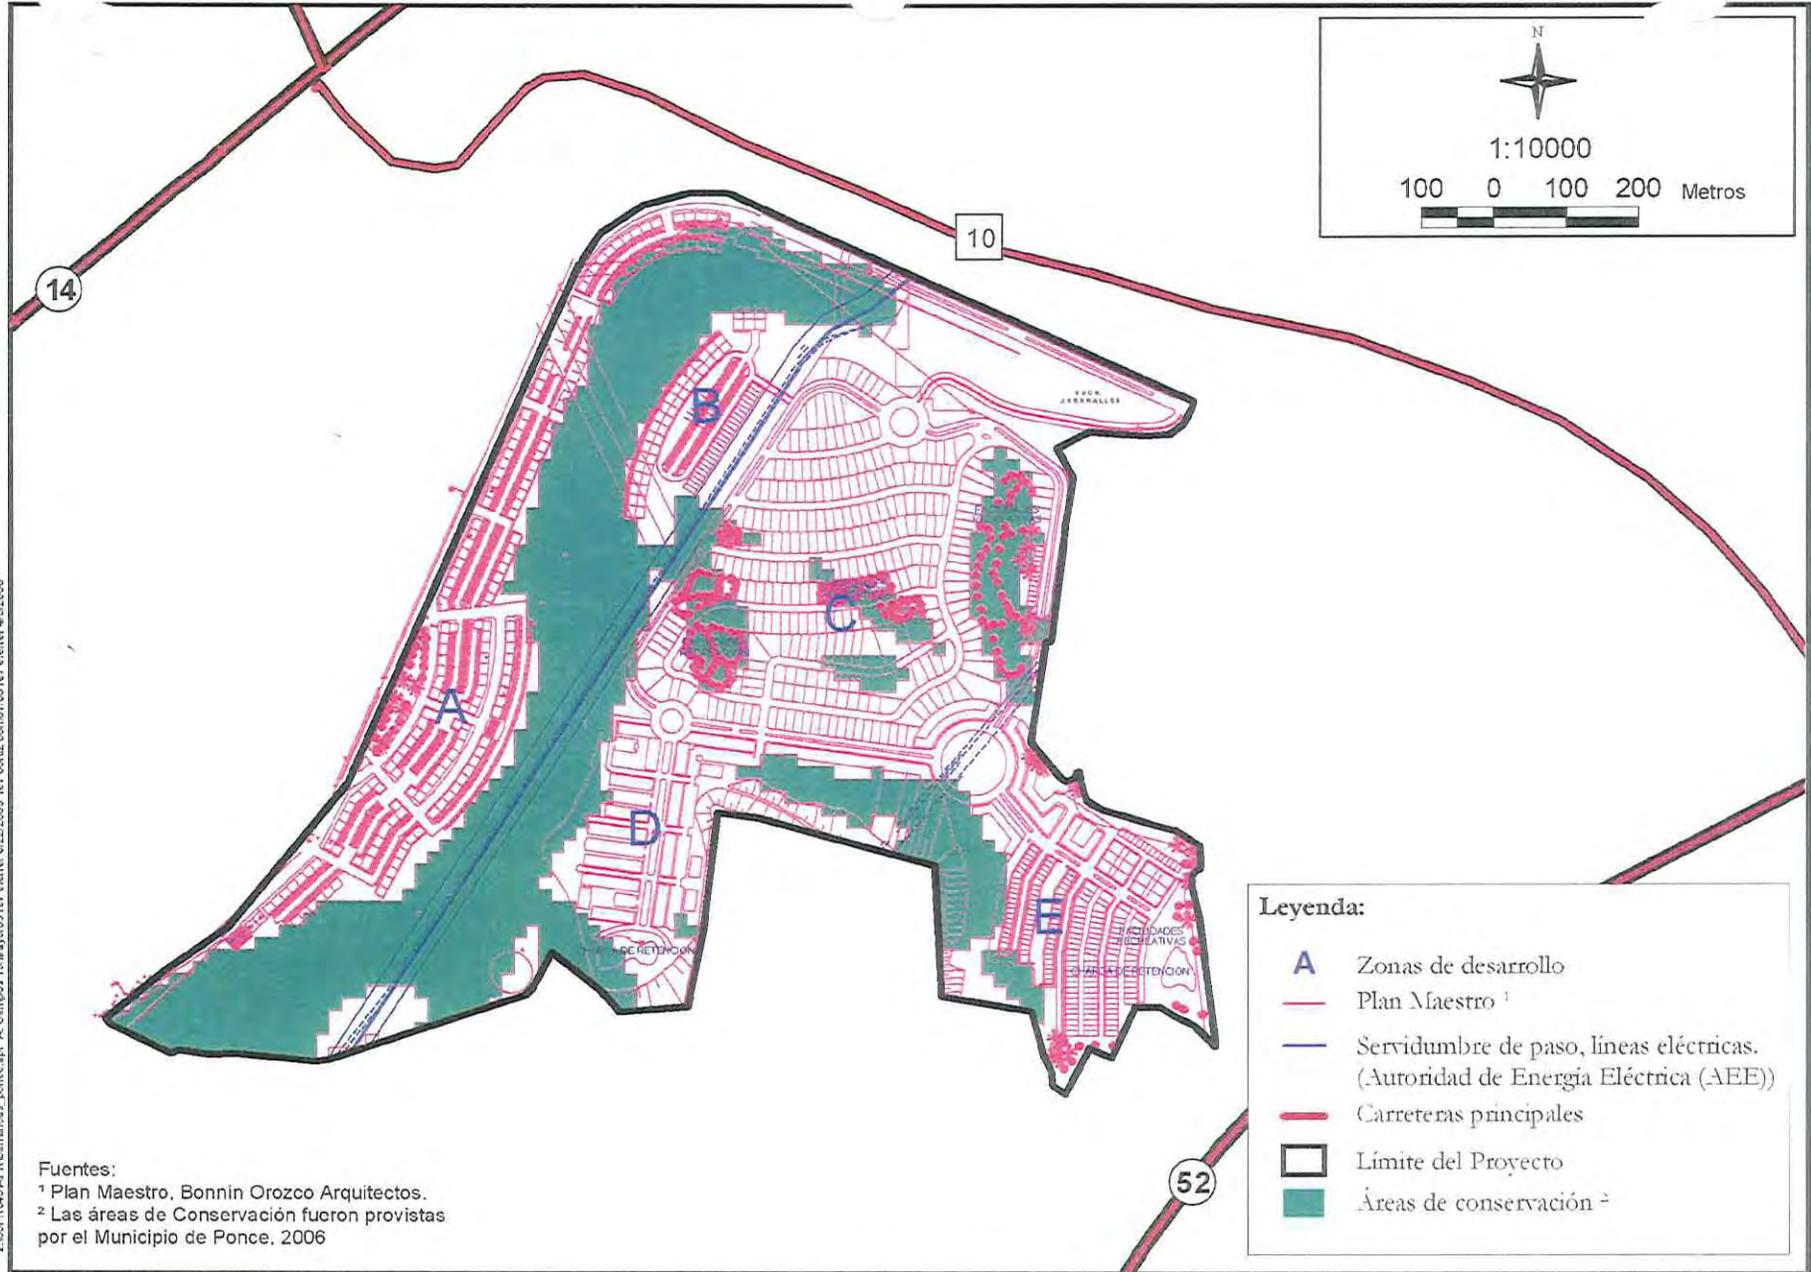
Plano Esquemático Actualizado del Proyecto Propuesto
